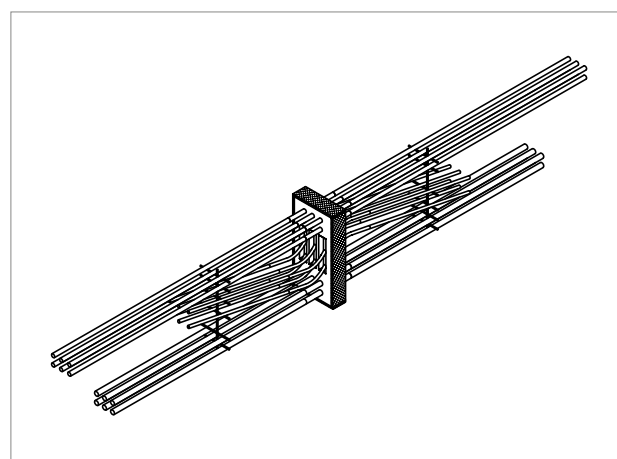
Schöck Isokorb® T Type B : Panneaux de protection incendie sur tout le pourtour
